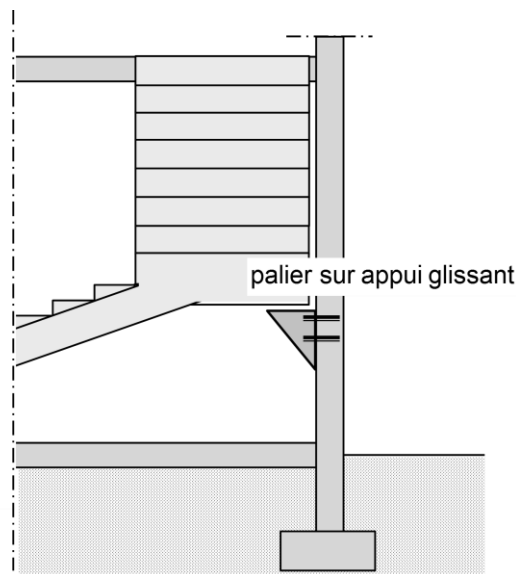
exemple de l'utilisation d'un appui glissant
